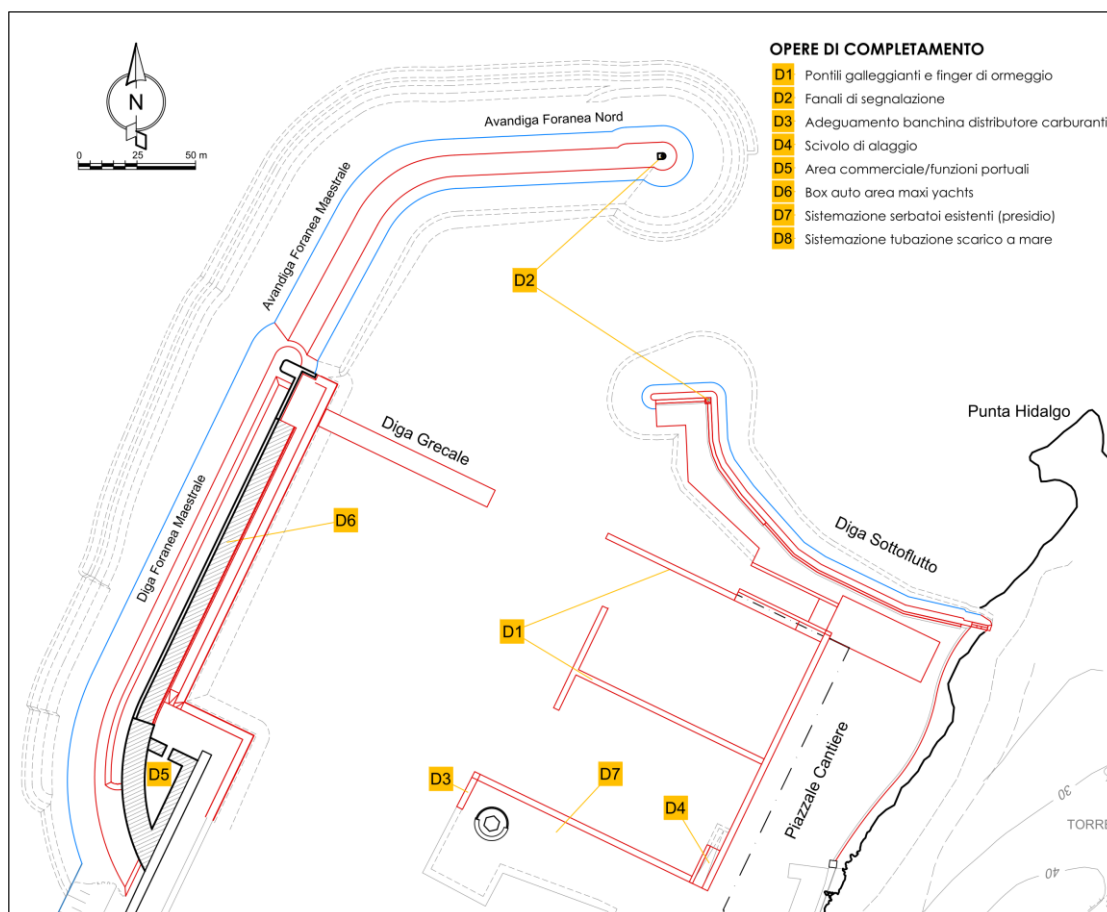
Indicazione delle opere di completamento previste da progetto
